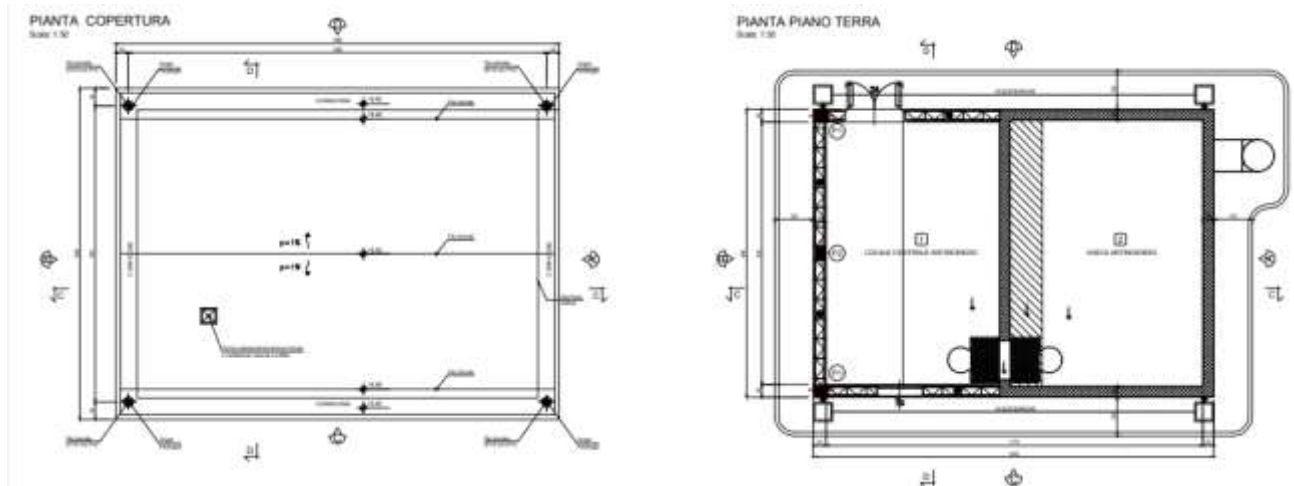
Pianta di copertura (a sinistra) e piano terra (a destra) - Fabbricato FAVM – progetto in variante
